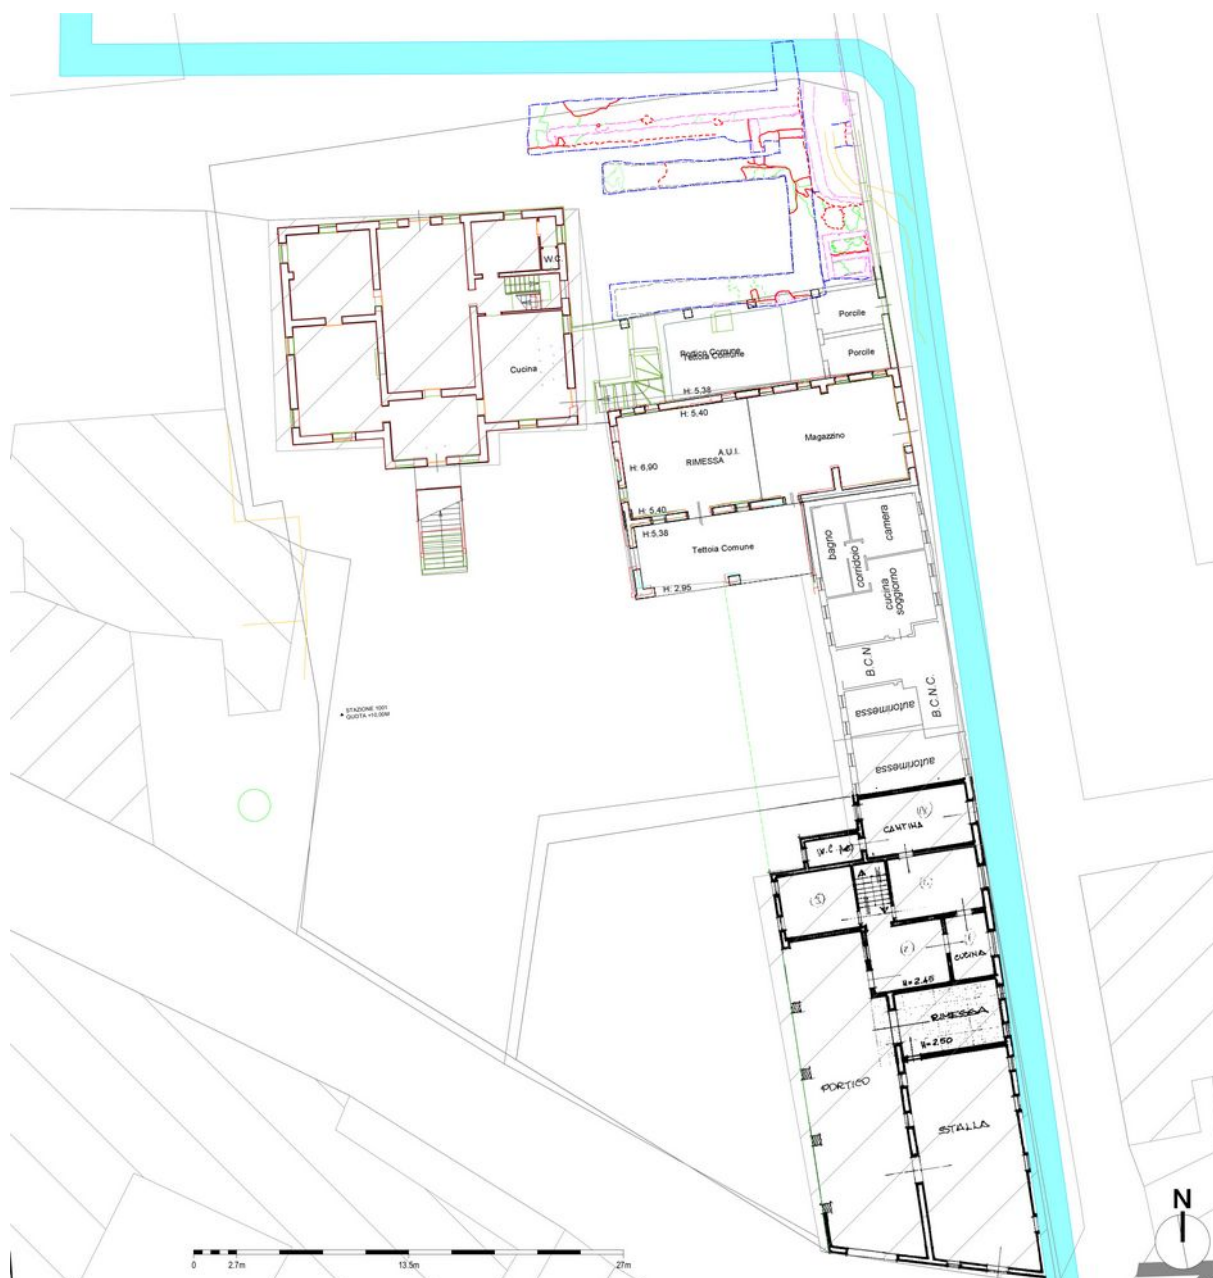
Planimetria catastale con sovrapposizione delle aree di indagine e la ricostruzione del tracciato della roggia del 1830
